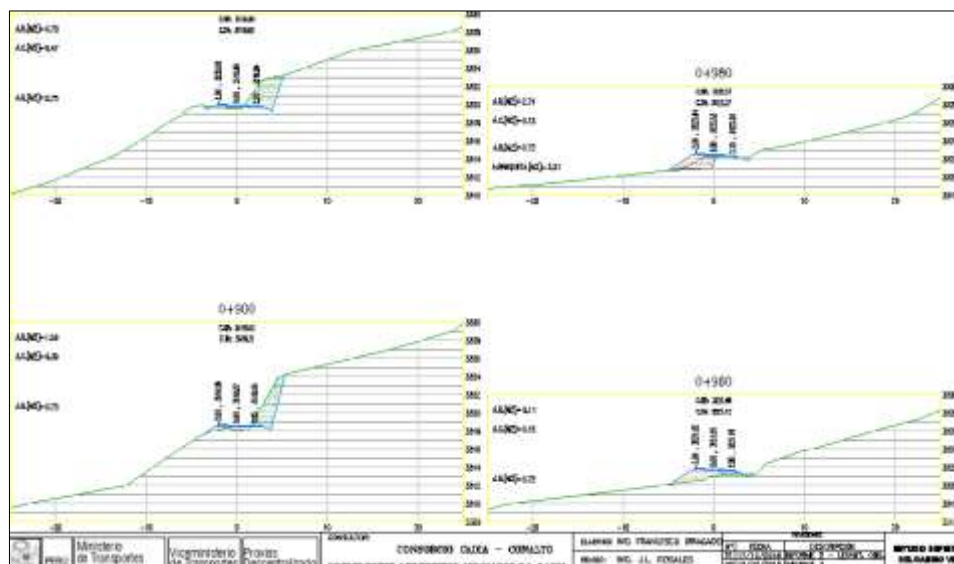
Ubicación de las Guardavias en Secciones. Fuente Plano de Secciones típicas ST-07
